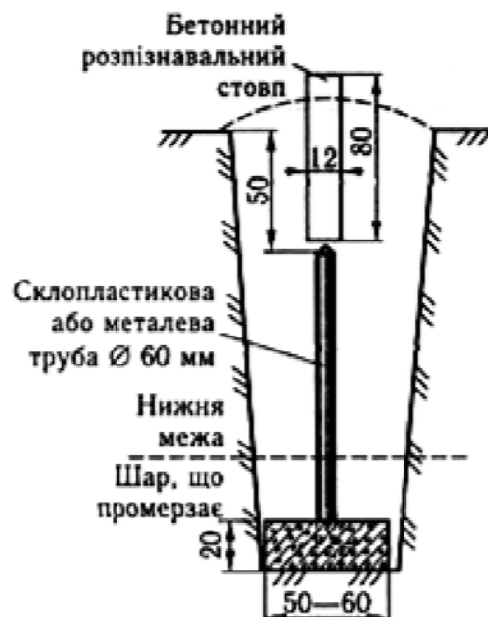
Ґрунтовий фундаментальний репер
